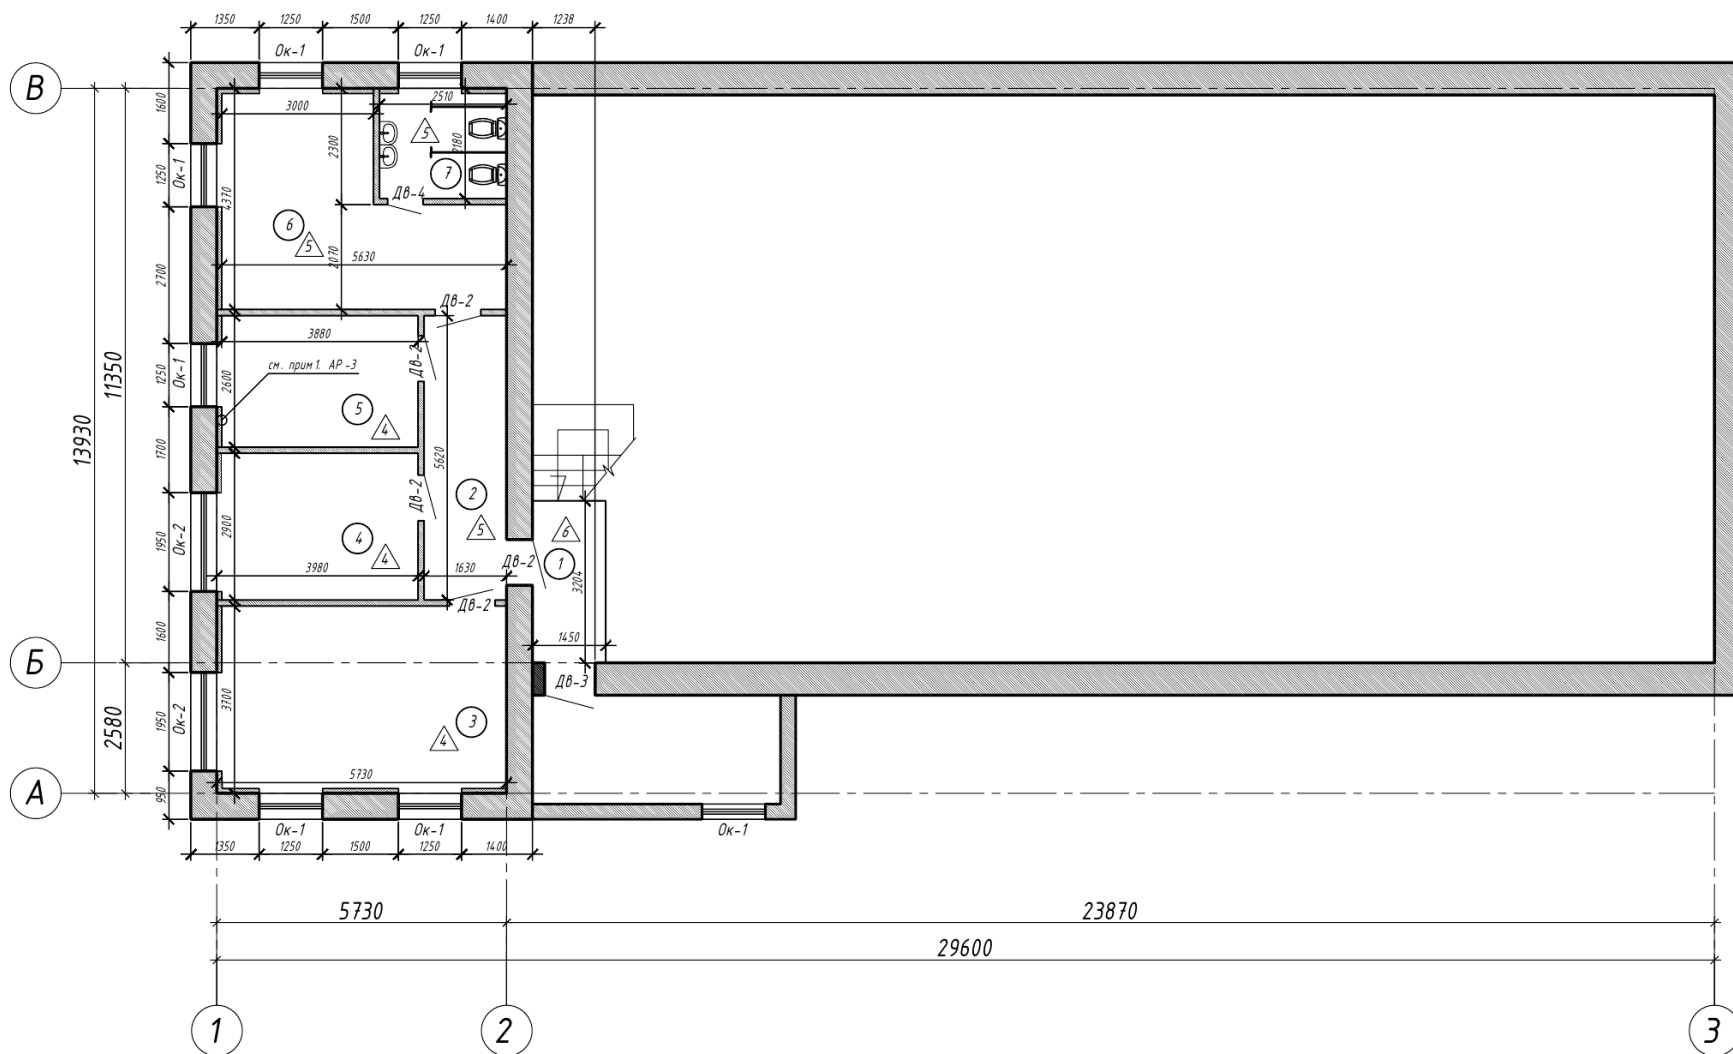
Схема планировки 2 этажа здания эллинга
